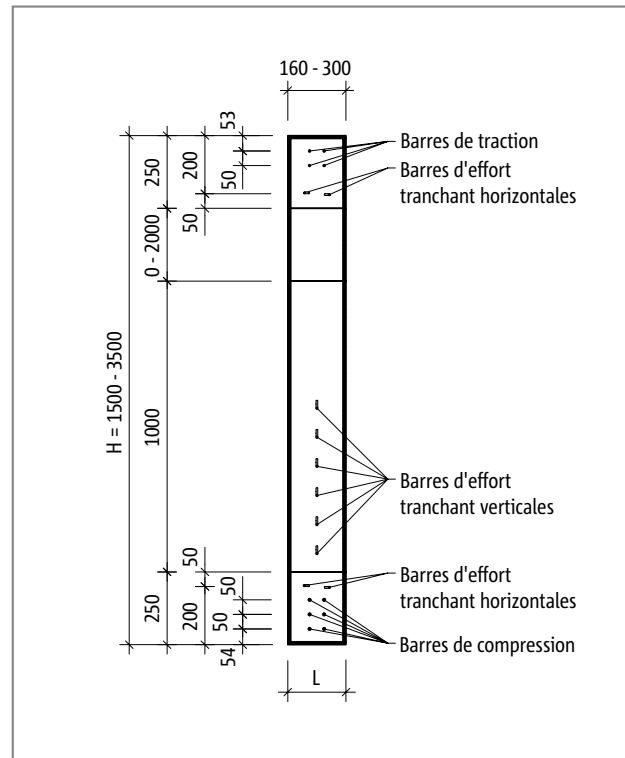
Schöck Isokorb® T Type W-M1 : Vue du produit
